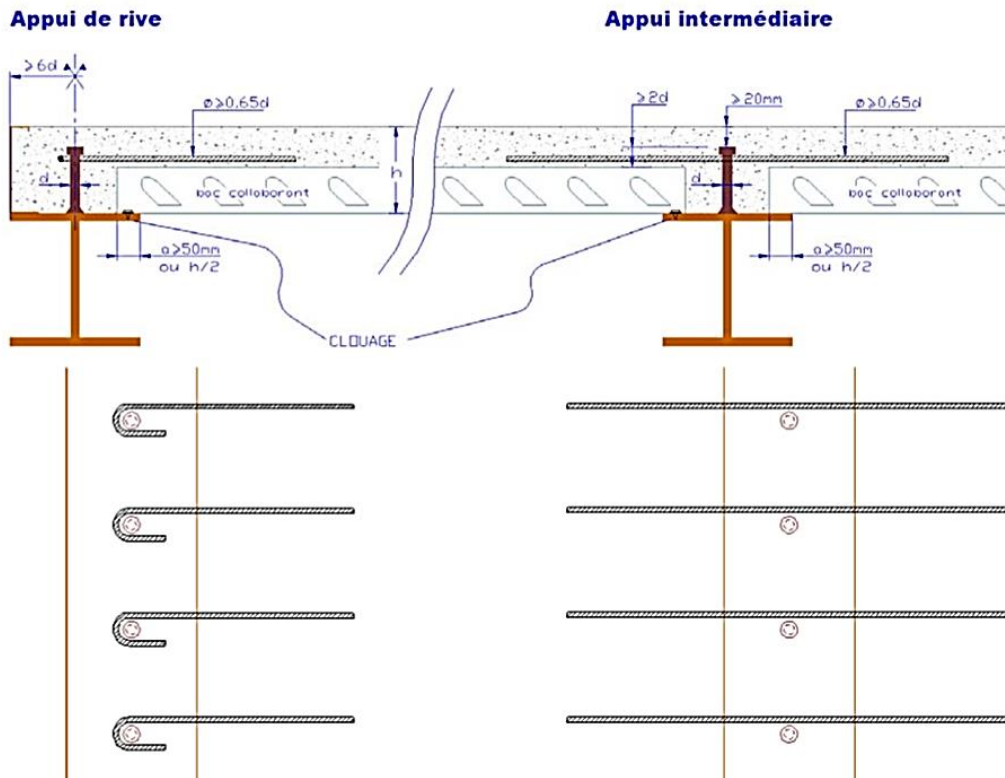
la mise en œuvre d'un plancher collaborant sur un appui en acier (source : <http://www.ccfat.fr/doc/avis-techniques/procedure-atec-fr.pdf>)
